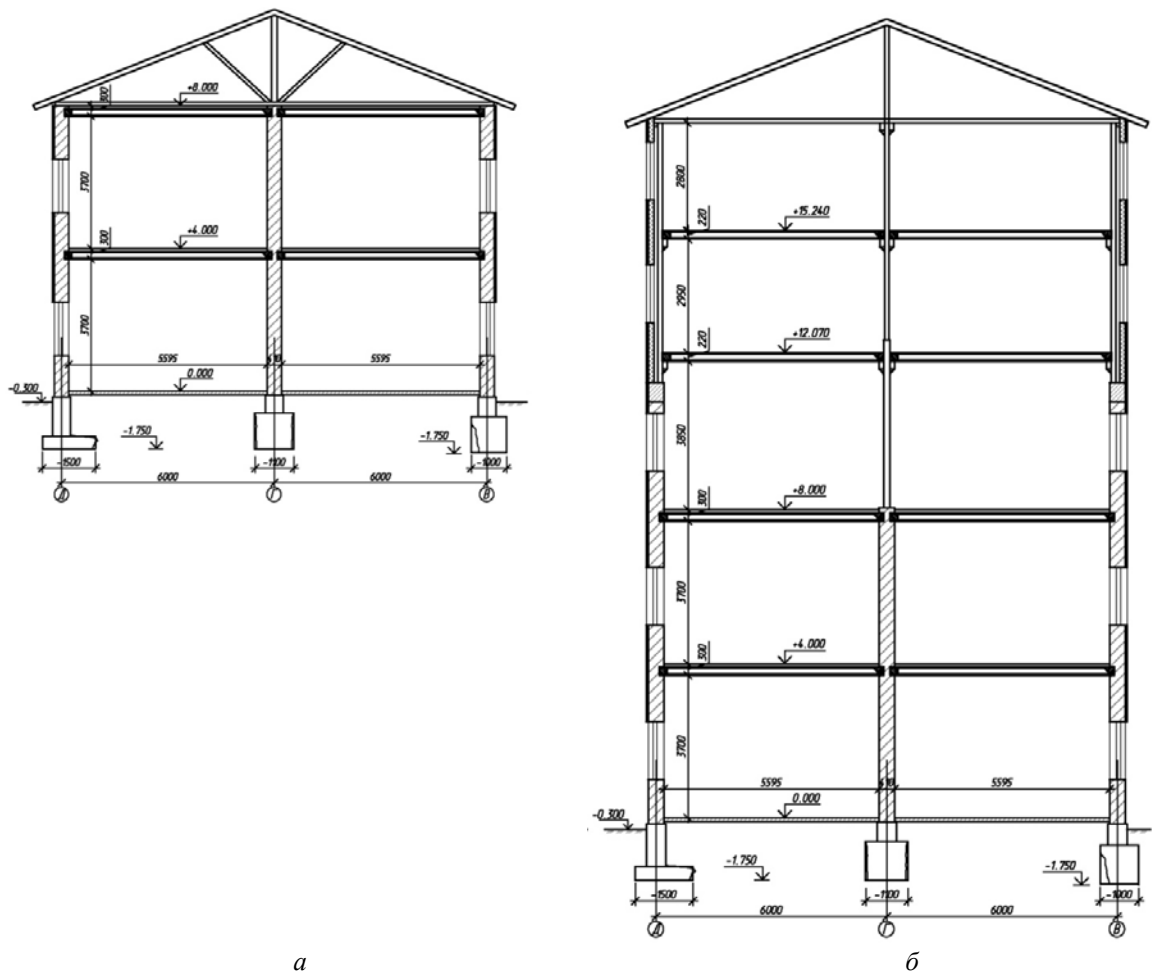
Поперечний переріз будівлі секції I: а – до надбудови; б – після надбудови
